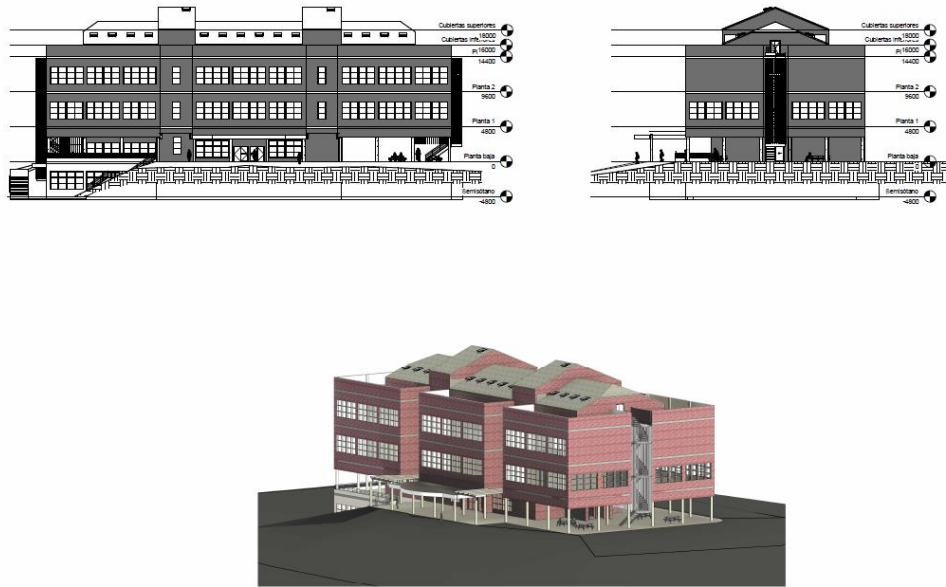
Plano de los alzados principal y este con una vista 3D del conjunto, realizado con Revit 2022
